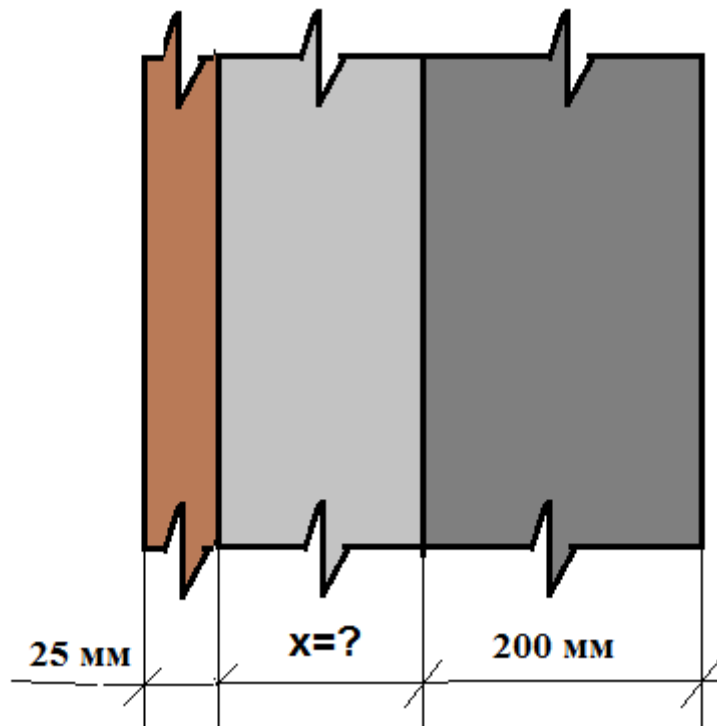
Розрахункова схема зовнішньої стіни
